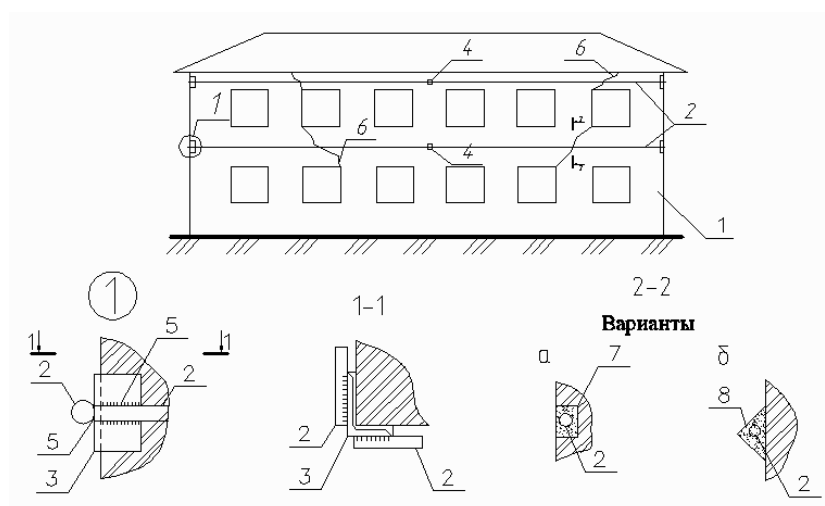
Усиление стен устройством напряженных металлических поясов с наружной стороны здания: 1 – деформируемое здание; 2 – стальные тяжи; 3 – прокатный профиль из уголка; 4 – стяжные муфты; 5 – сварной шов; 6 – трещины в стенах; 7 – штраба в стене для тяжа, заполненная цементно-песчаным раствором; 8 – промежуточный карниз из цементно-песчаного раствора
